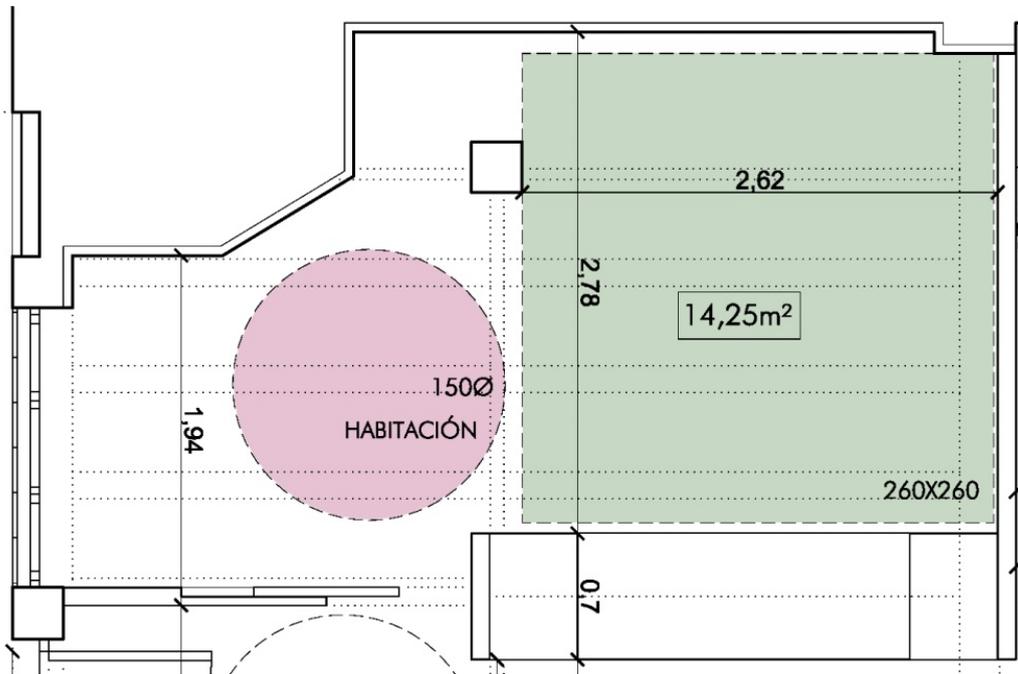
Plano figuras mínimas inscribibles dormitorio. Fuente propia.
